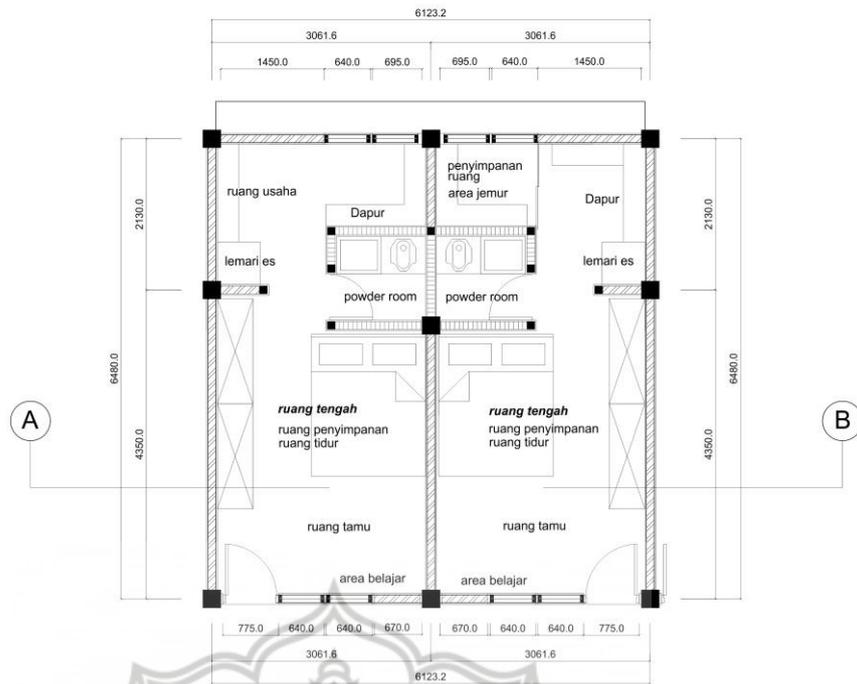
Denah Lantai tiga dan empat Blok A
